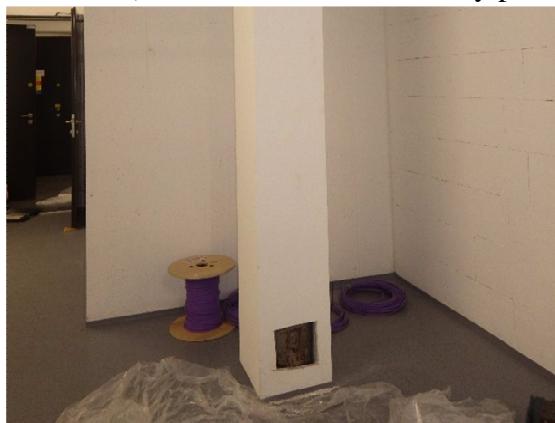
sonda NS-B7--obnažená část; Foto č.38--sonda NS-B8--celkový pohled
